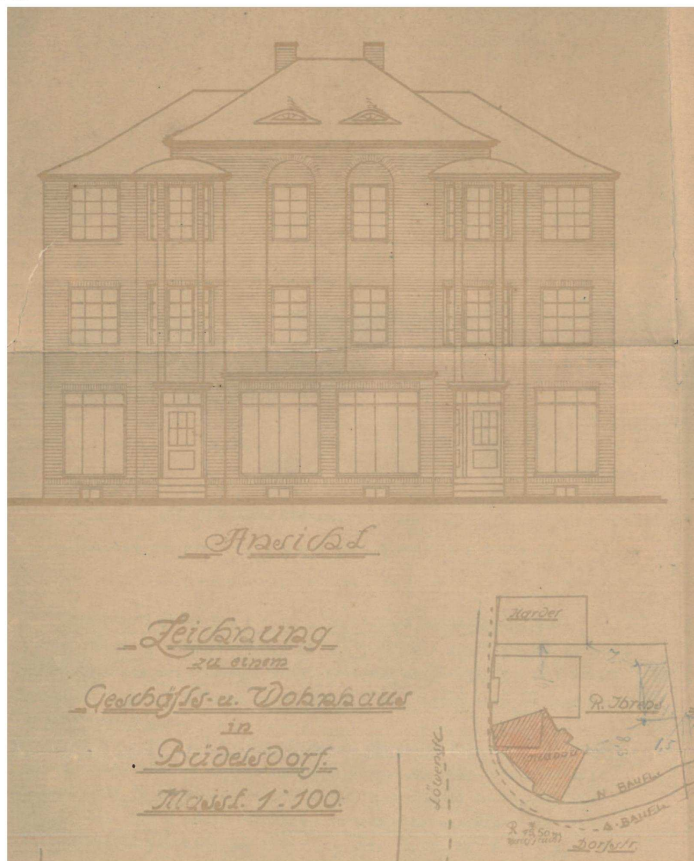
Fassadenzeichnung inkl. Lageplan des überarbeiteten Entwurfs
